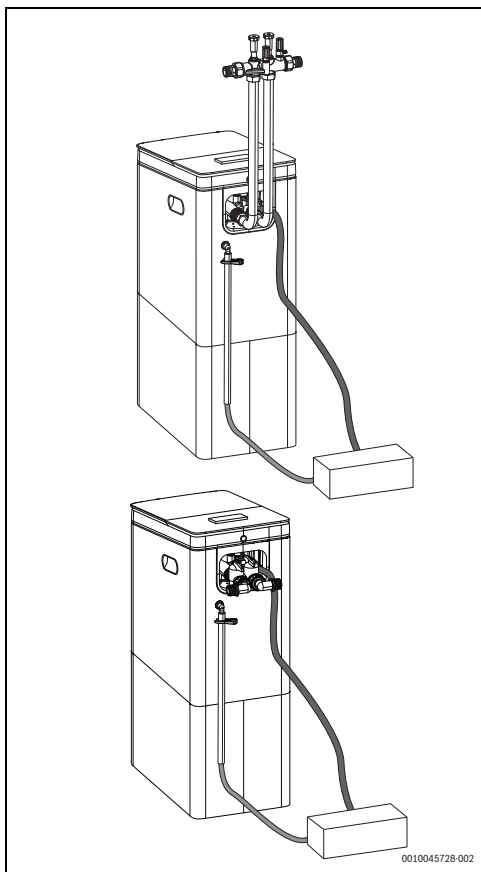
Vue d'ensemble du tube coudé de trop-plein et du tuyau d'évacuation après l'installation
